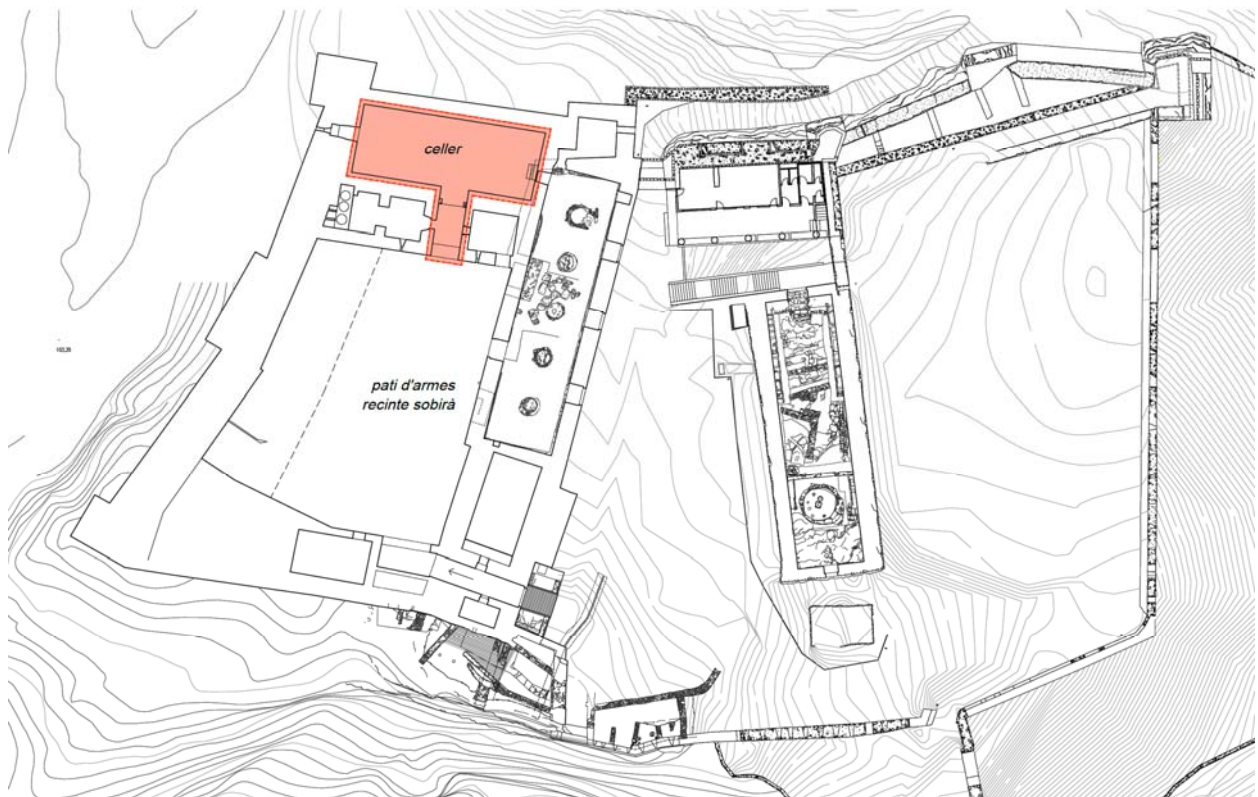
Planta del castell de Miravet amb indicació de la ubicació de l'àmbit de l'actuació.
